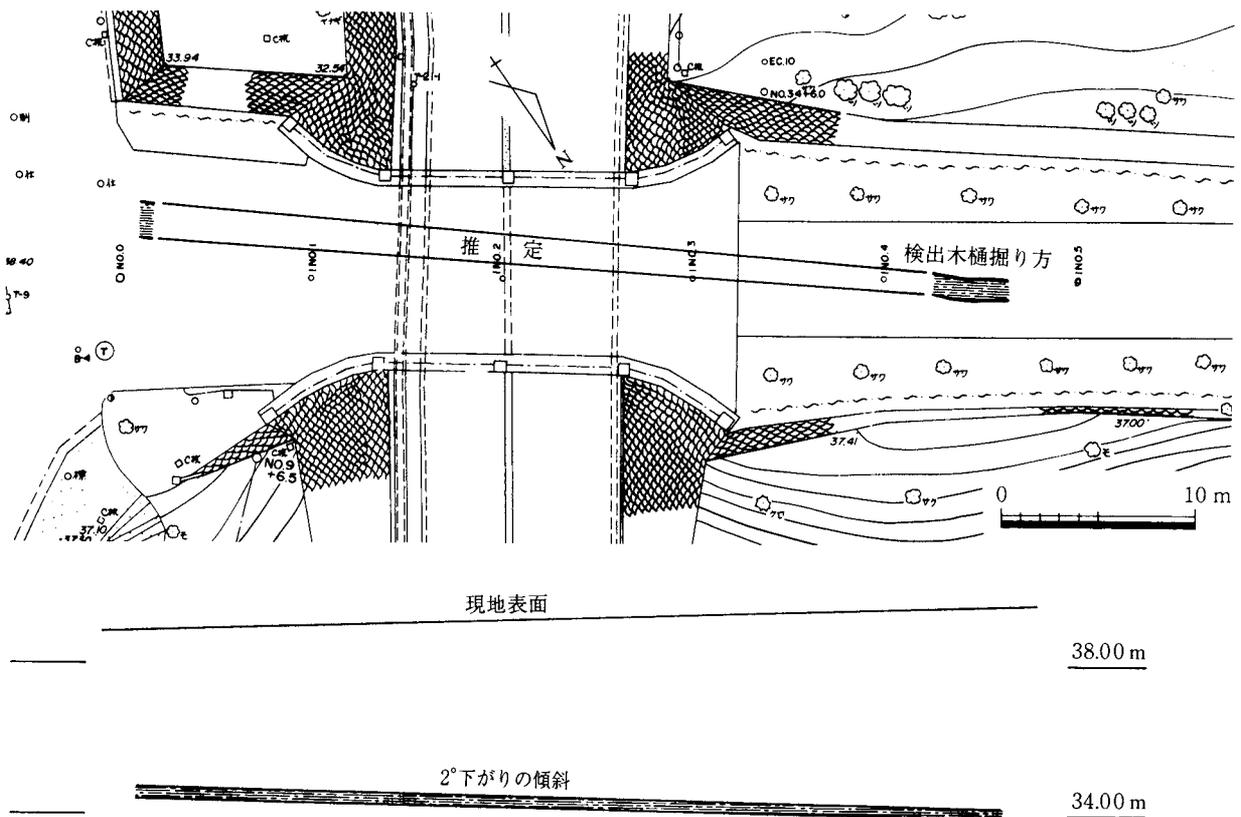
木樋設置推定位置図（平面図1/400、断面図高底1/200）
